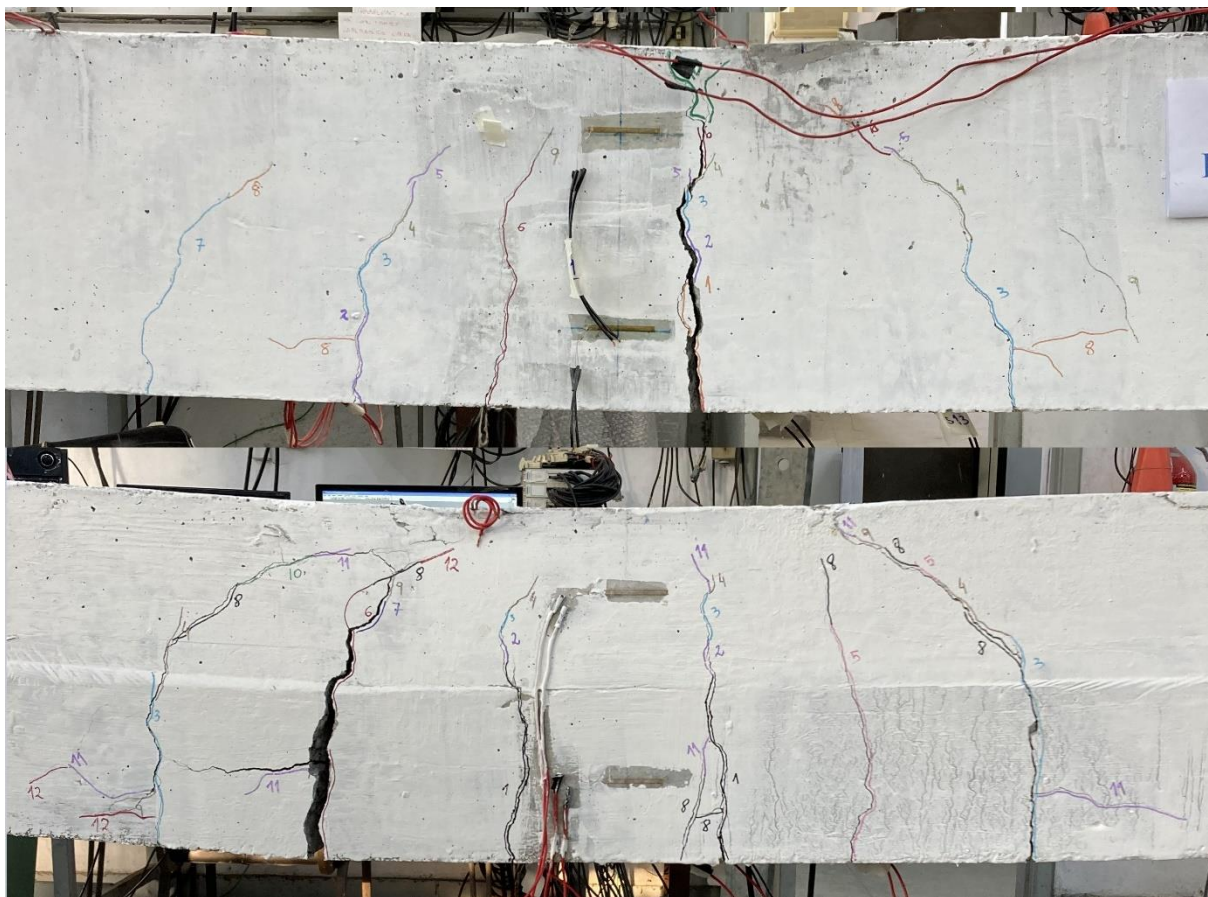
Comparativo das fissuras entre as vigas após a ruptura.
